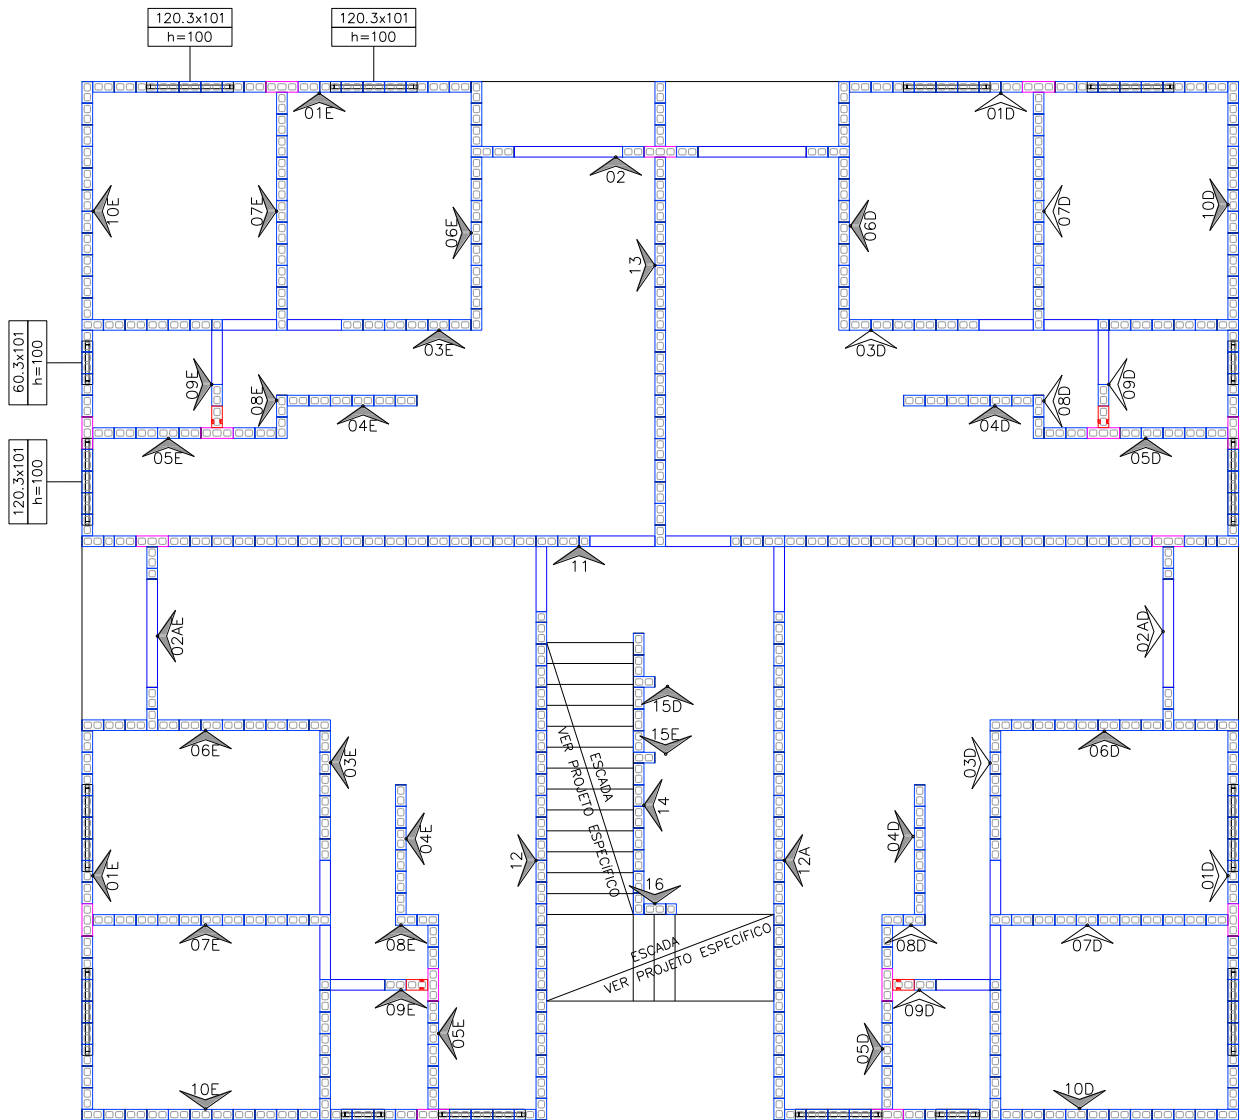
Edifício Vitória Jundiá: planta de modulação do pavimento tipo
